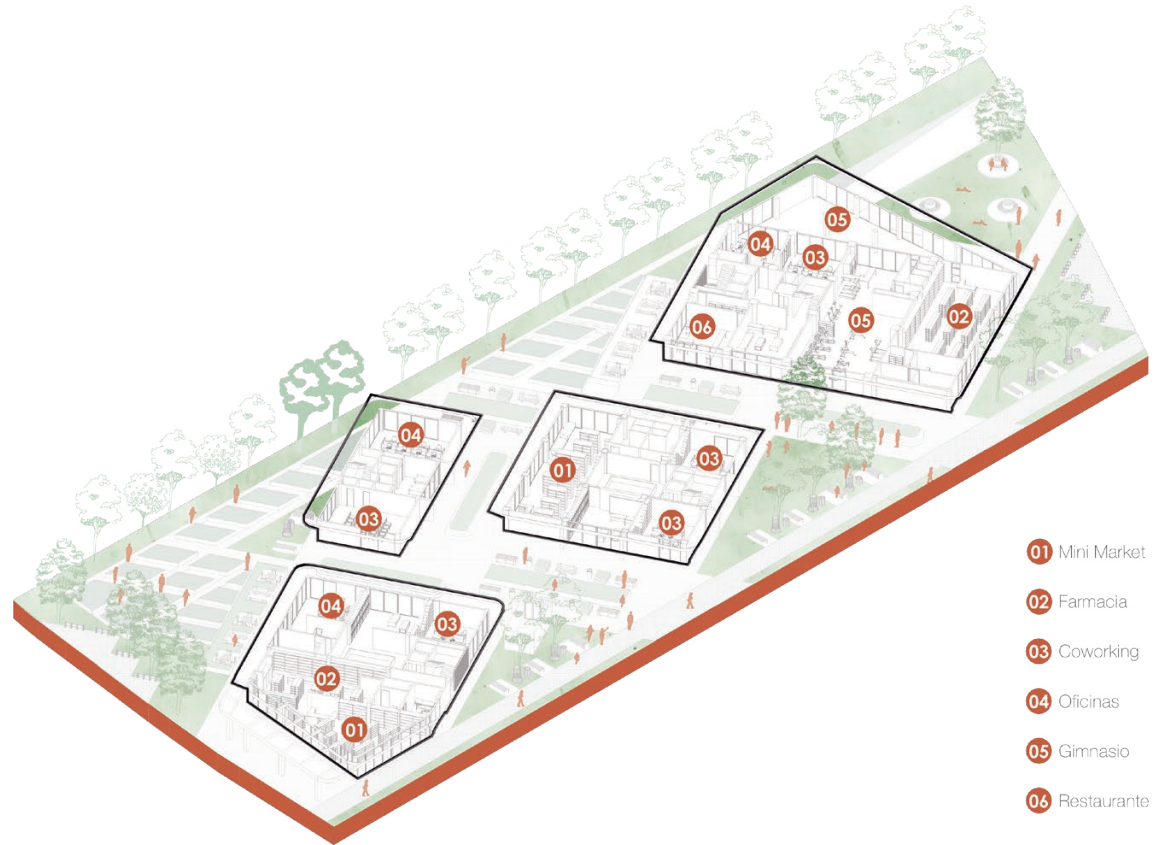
Axonometría usos Planta Baja Fuente: Elaboración Propia 2026
